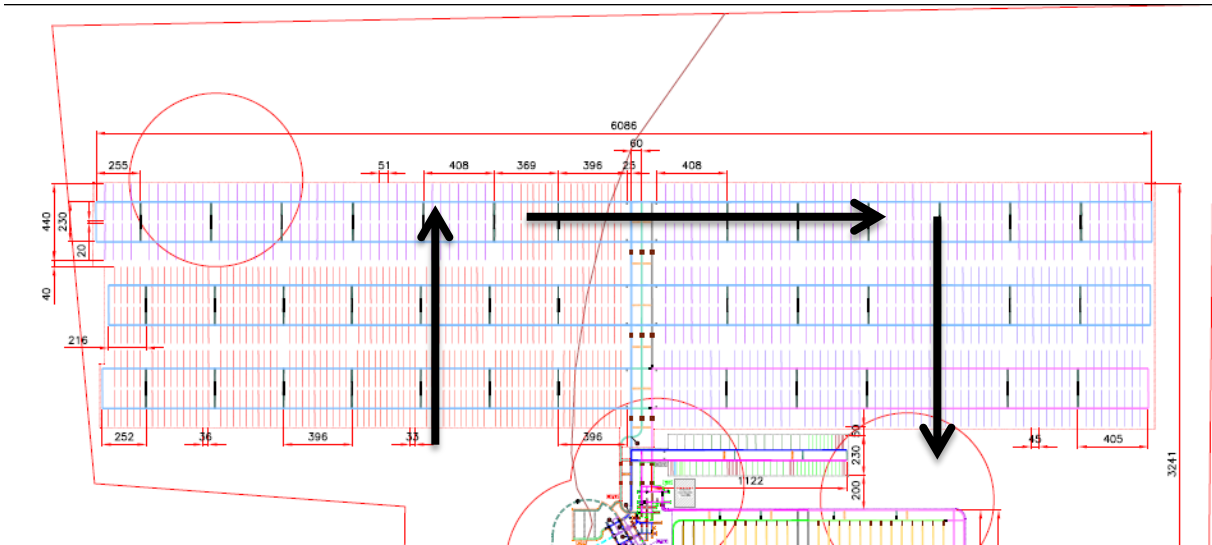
Plan masse de la zone HA1/2 à terminaison
